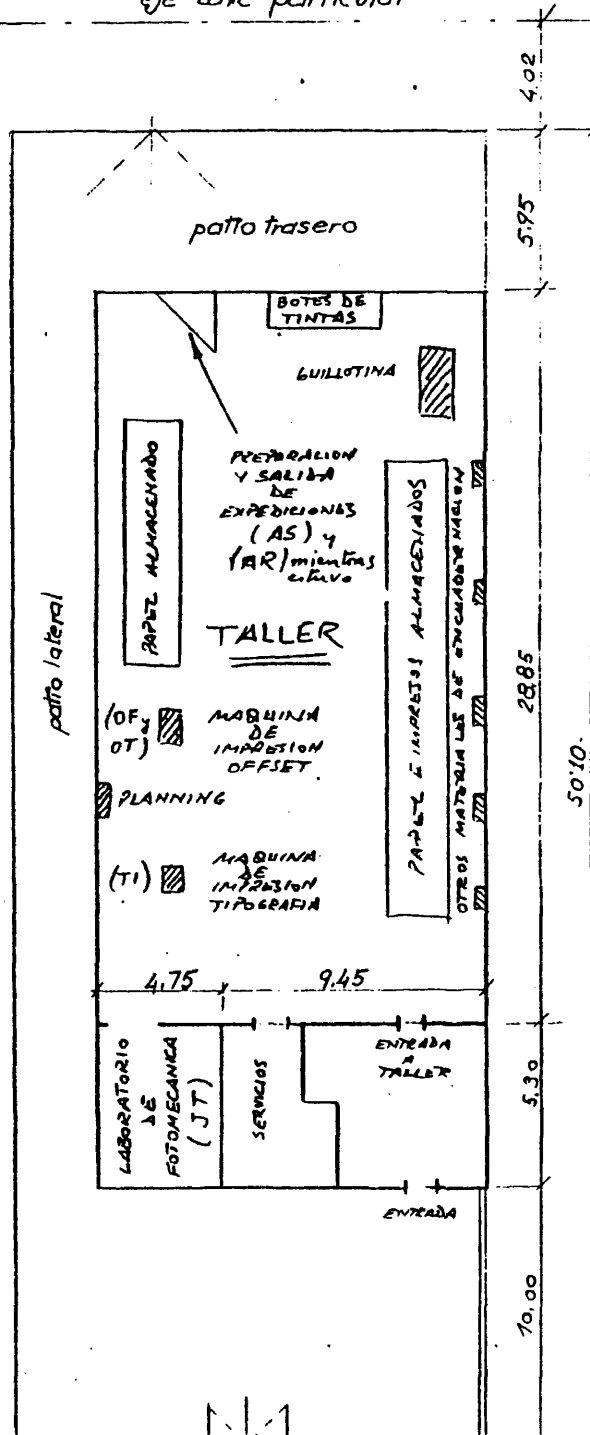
Planta baja de Ediciones Gamma: Recepción, Laboratorio de Fotomecánica y Planchas y Taller.
